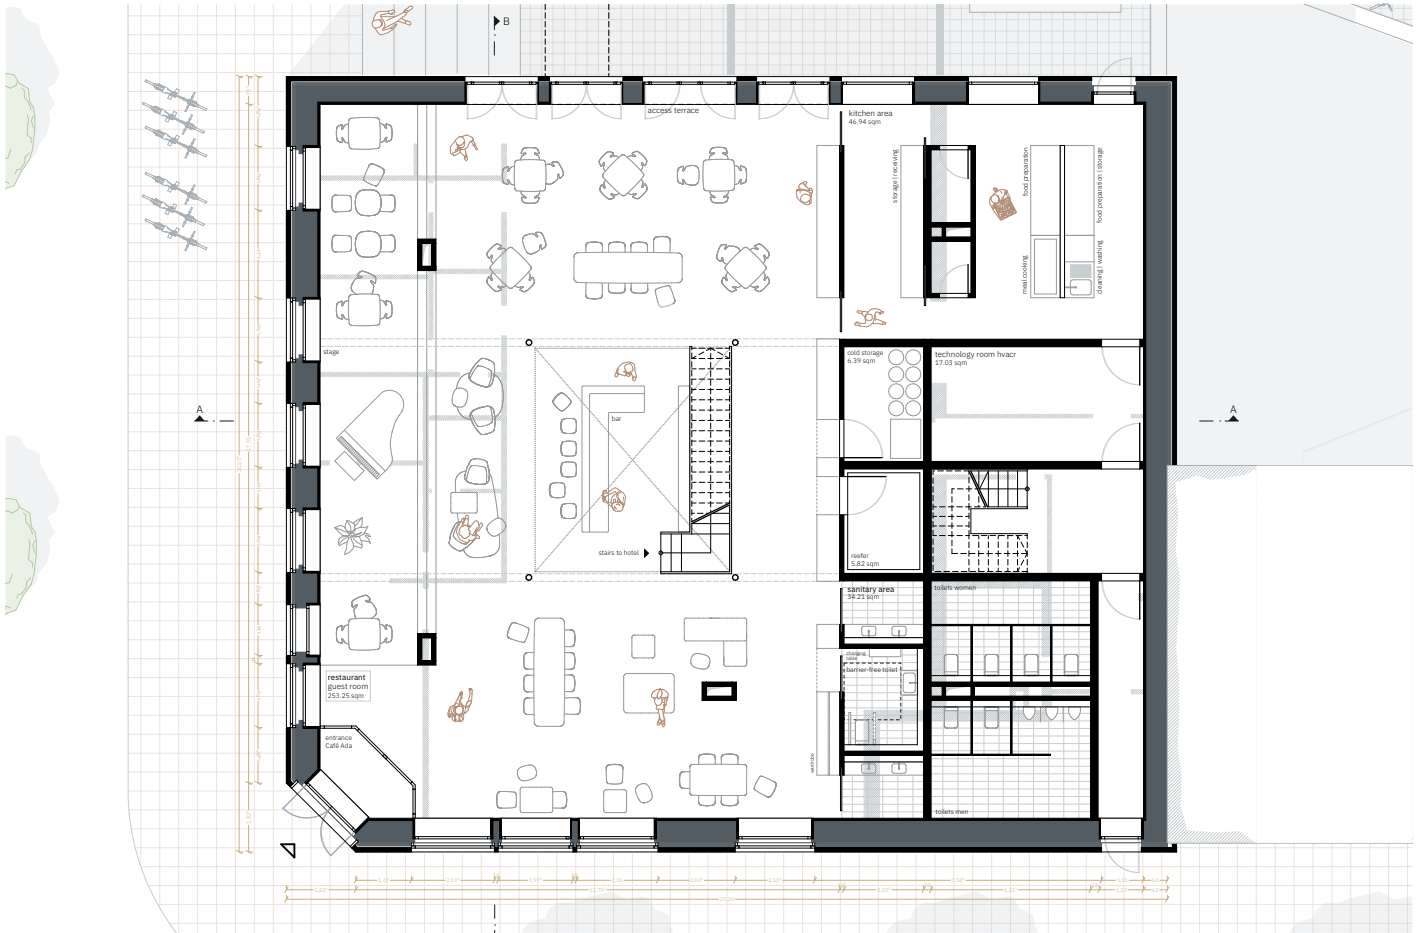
Erdgeschoss | Bestand Café Ada, M 1:200
